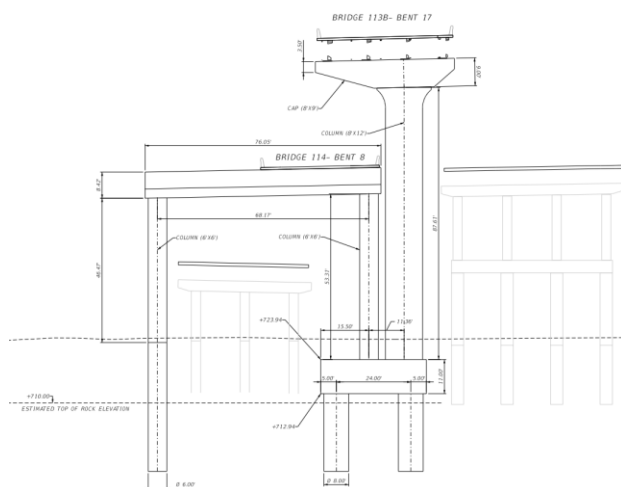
Alzado pila 17, excéntrica, del puente 113B y pila 8, "straddle bent", del puente 114.
